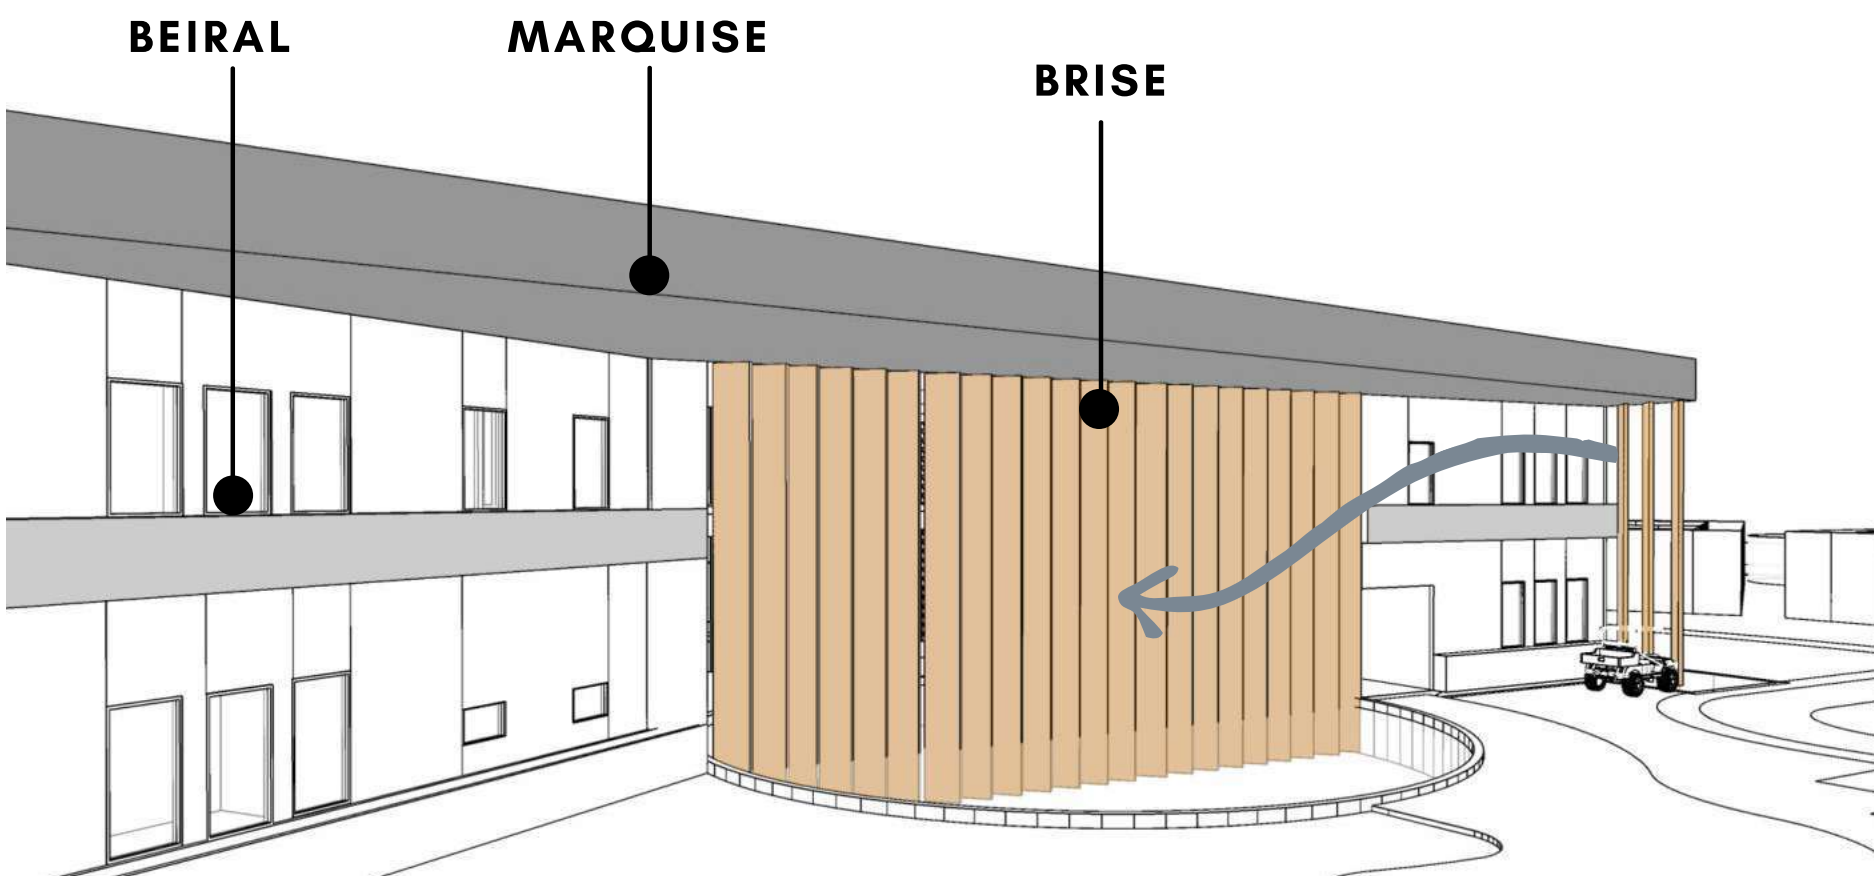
IMAGEM ESQUEMÁTICA DE PROTEÇÕES SOLARES: FACHADA LESTE
